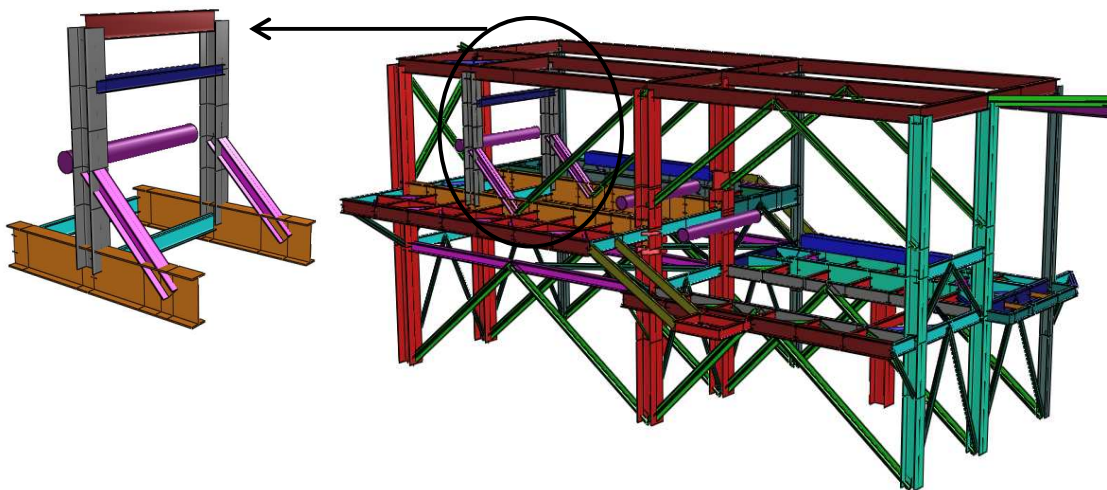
Modelo tridimensional da estrutura do modelo 02 (reforço estrutural) – Detalhe para a estrutura suporte do tambor
